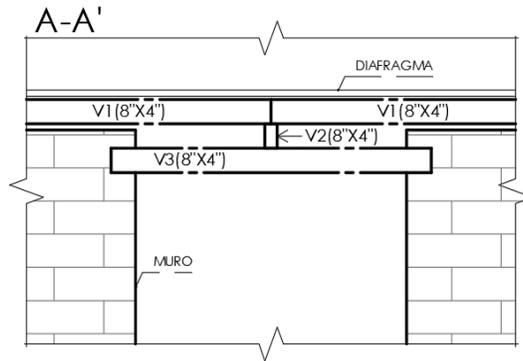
Alzado lateral de la propuesta 1. Imagen propiedad del autor.
